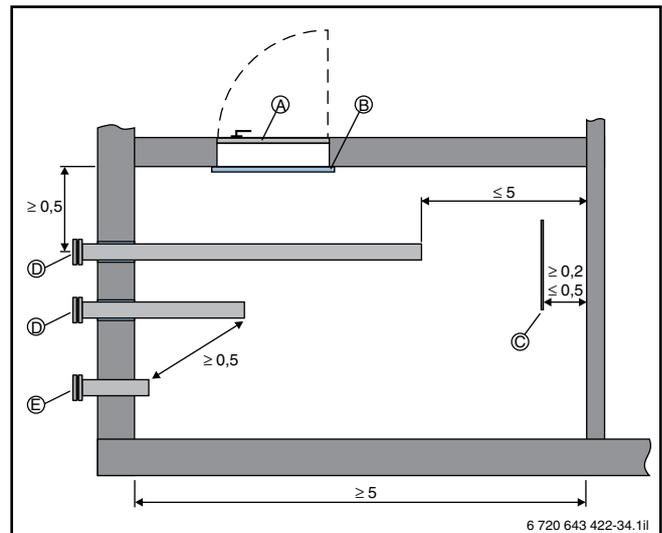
Sezione (vista dall'alto) di un deposito di pellet con lunghezza del locale ≥ 5 m (quote in m)
